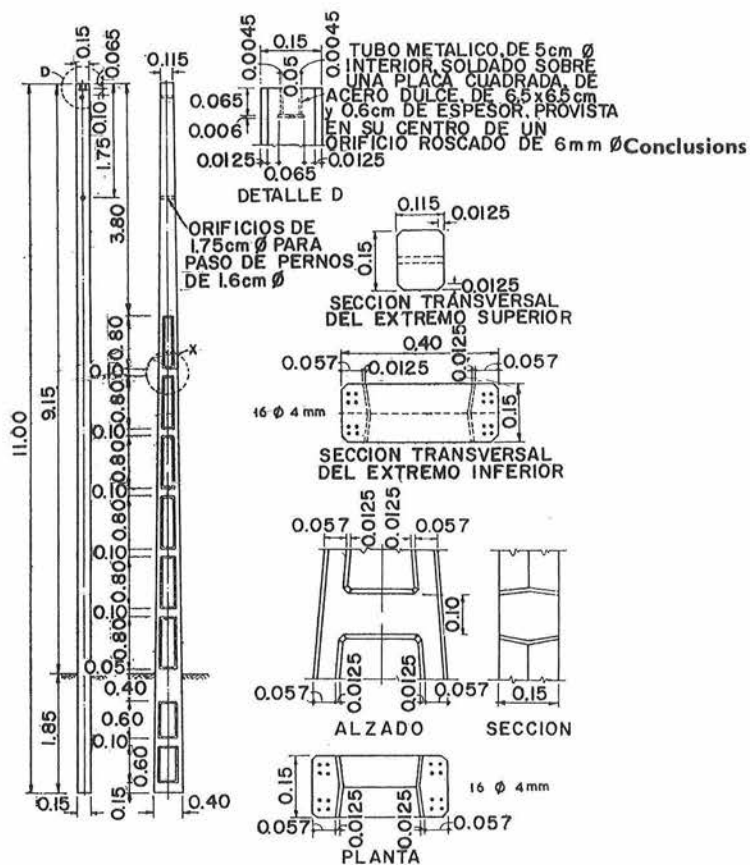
Detalle de uno de los postes de hormigón pretensado tipo Vierendeel, 36/400. Estos postes tipo Vierendeel requieren cimentación de hormigón.
